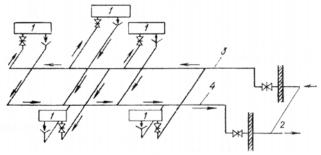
Схема циркуляционных сетей производственных водопроводов: 1 – оборудование, цехи и т.п.; 2 – водопроводные сети; 3 – напорная циркуляционная сеть; 4 – самотечная циркуляционная сеть
